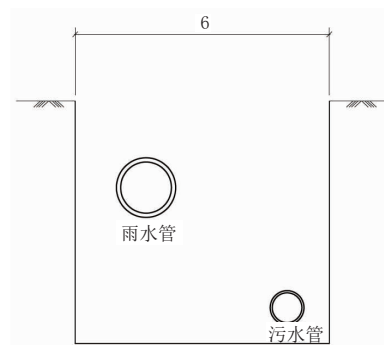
钢板桩支护、雨污水同槽施工方案(单位:m)
